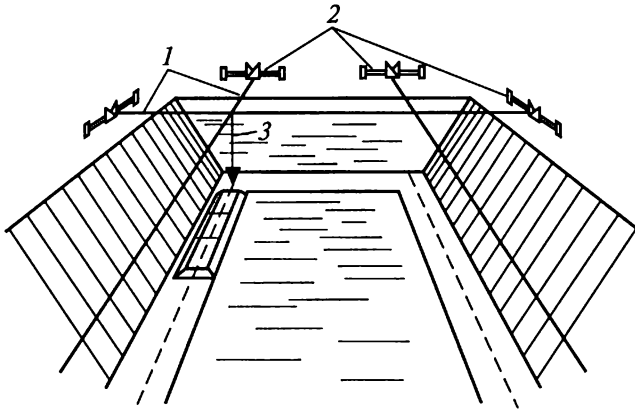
Схема разбивки ленточных сборных фундаментов:
